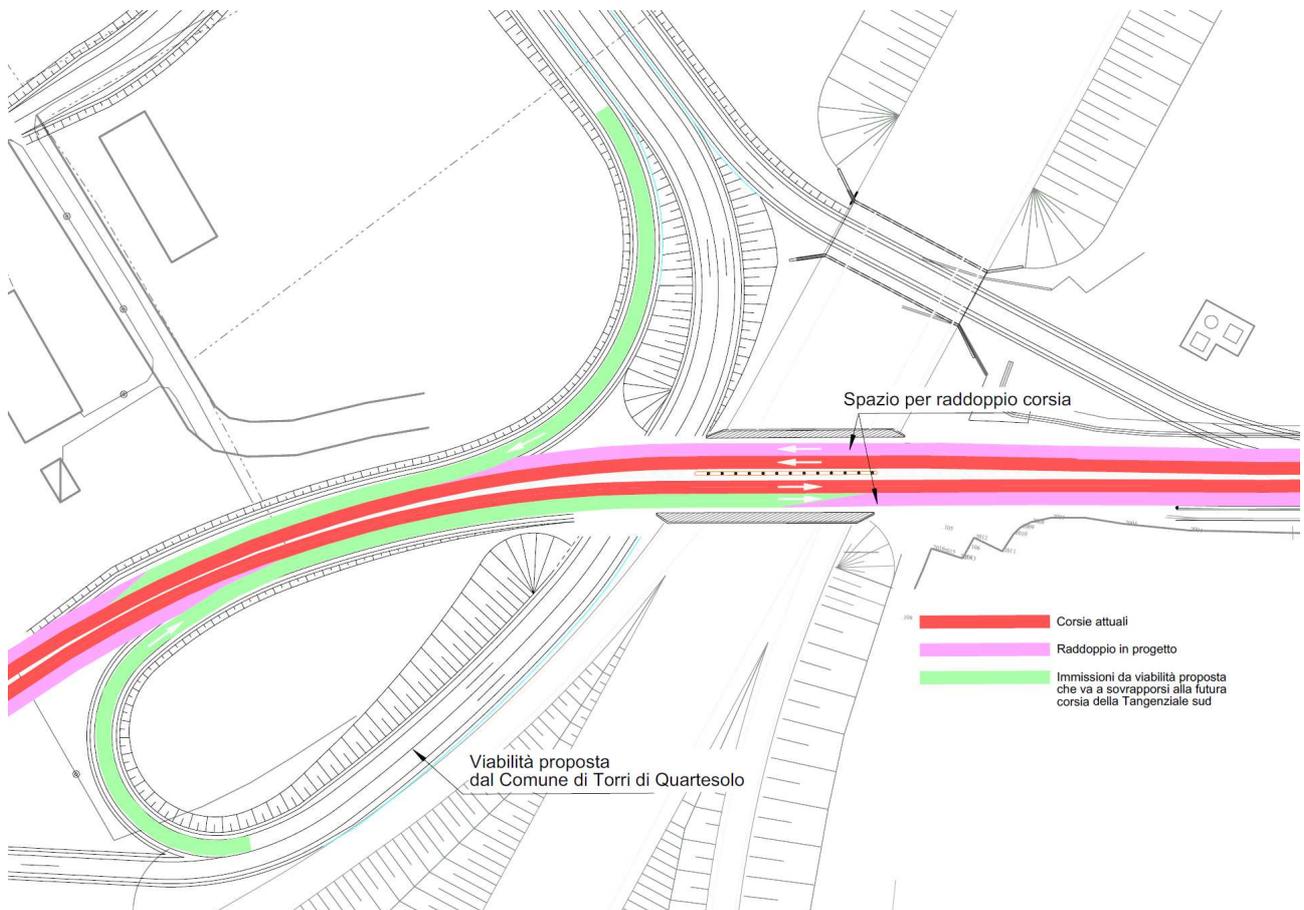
Planimetria di progetto di raddoppio della carreggiata della Tangenziale Sud
